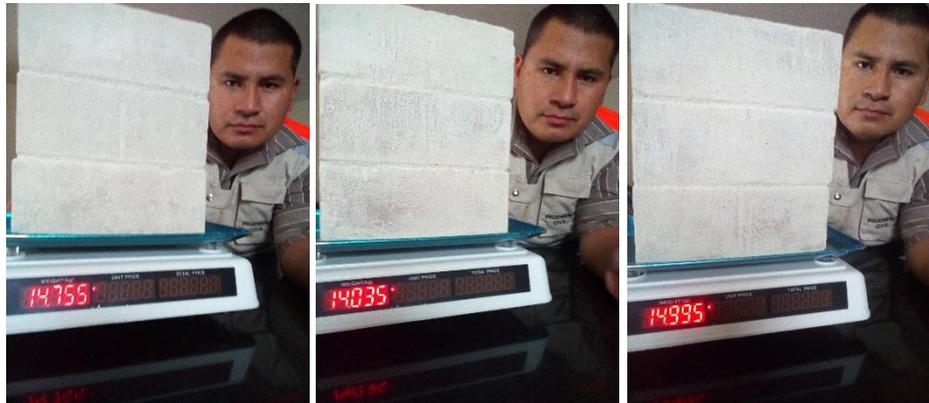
Se realizo la impermeabilización a la superficie de los muretes de ladrillo.
